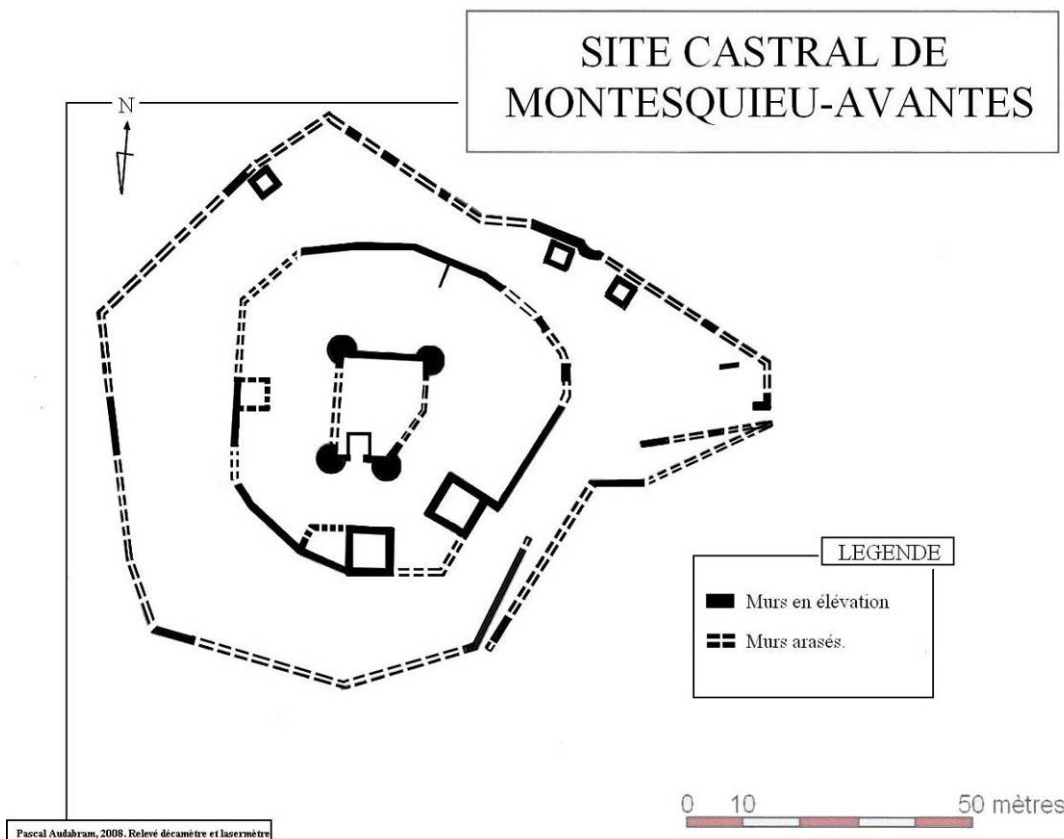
Plan de masse du site castral (Pascal Audabram)
